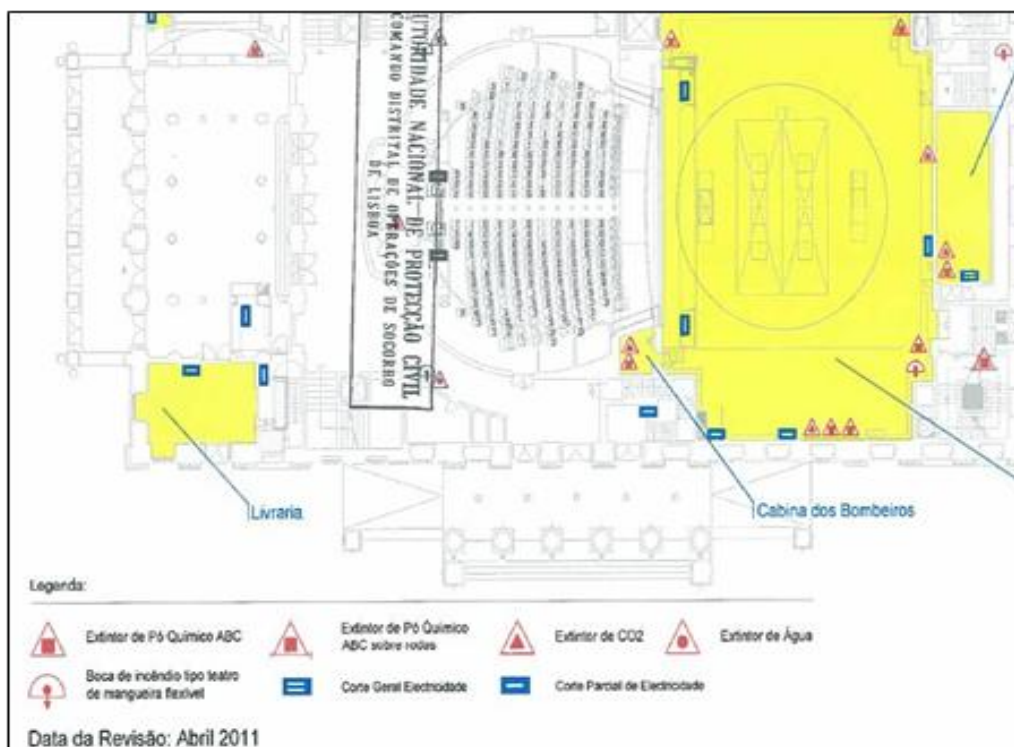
Parte do Plano de Atuação da sala Garrett [10]
